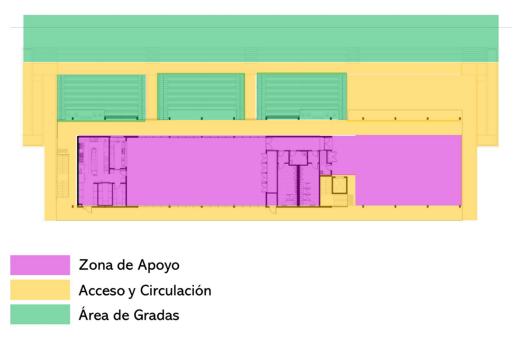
, Elaboración propia, Plantas (Dwp Arquitectos 2021)
